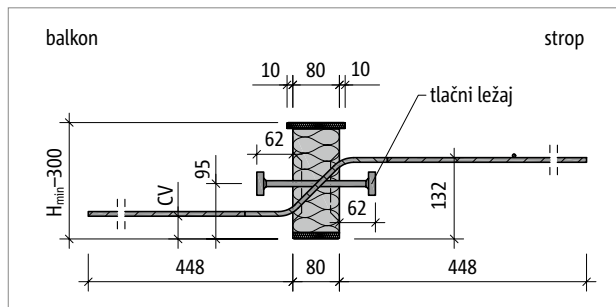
Schöck Isokorb® T tip QL-V6: tloris proizvoda
